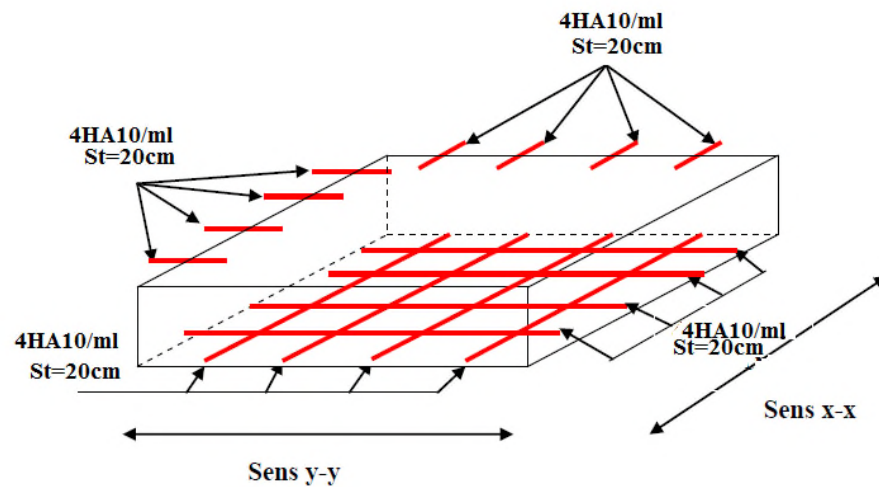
Schéma de ferrailage de la dalle pleine au-dessus de l'ascenseur.
